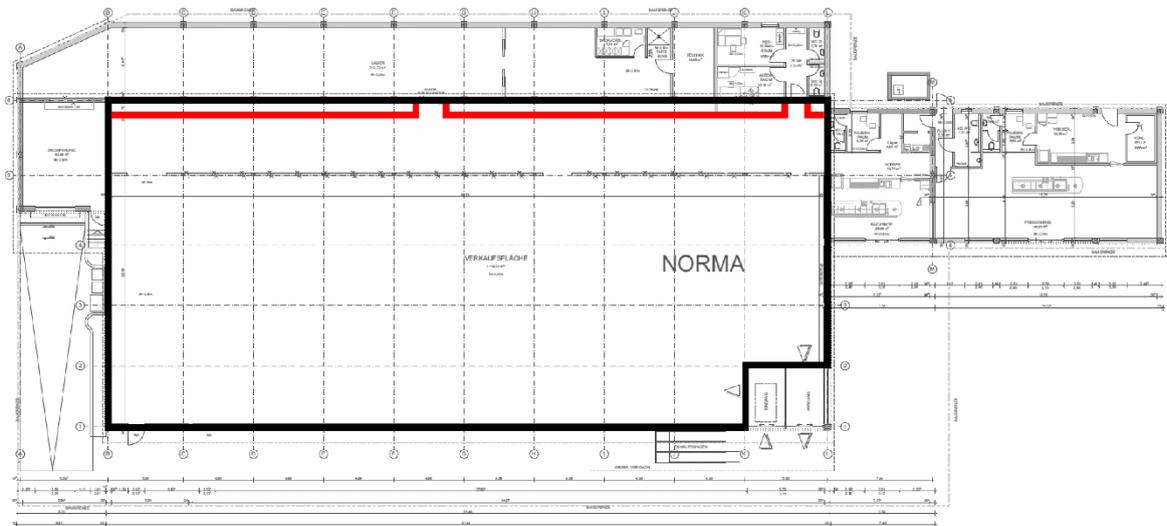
Grundriss des geplanten Umbaus (schwarz: Verkaufsraum, rot: Verkleinerung des Verkaufsraumes durch Trockenbauwand)
